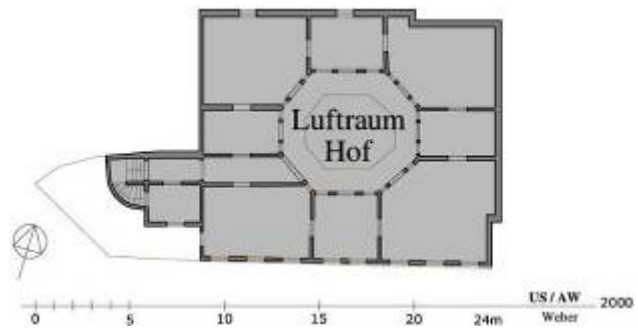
Wakālat al-ʿAššā, Grundriss 2.OG
